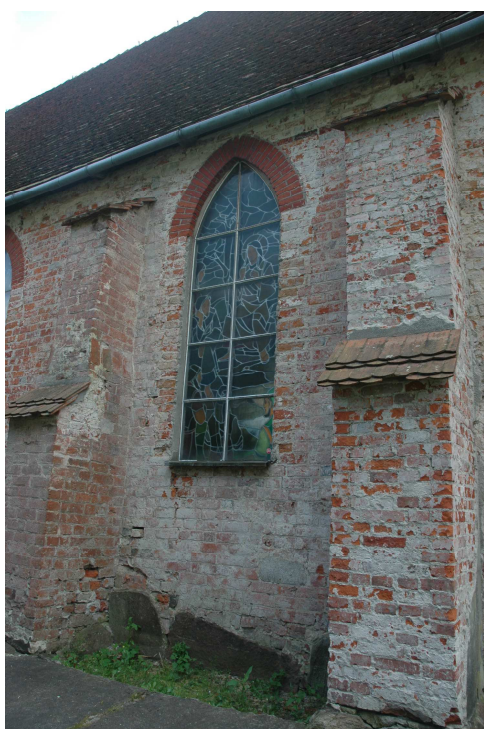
Zbliżenie na elewację południową po skuciu tynku
